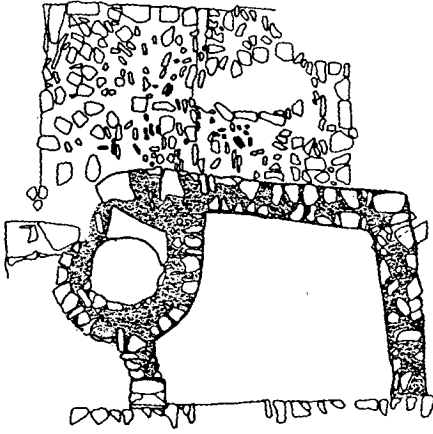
Planta y sección de pozo y depósito de la bodega.
